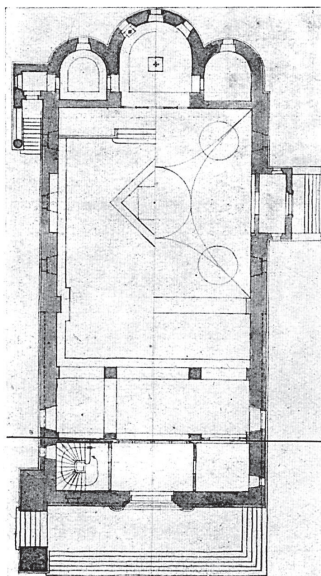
Arch. Edgar Norwerth. Projekt cerkwi murowanej. Polecony do zakupu. Plan.
